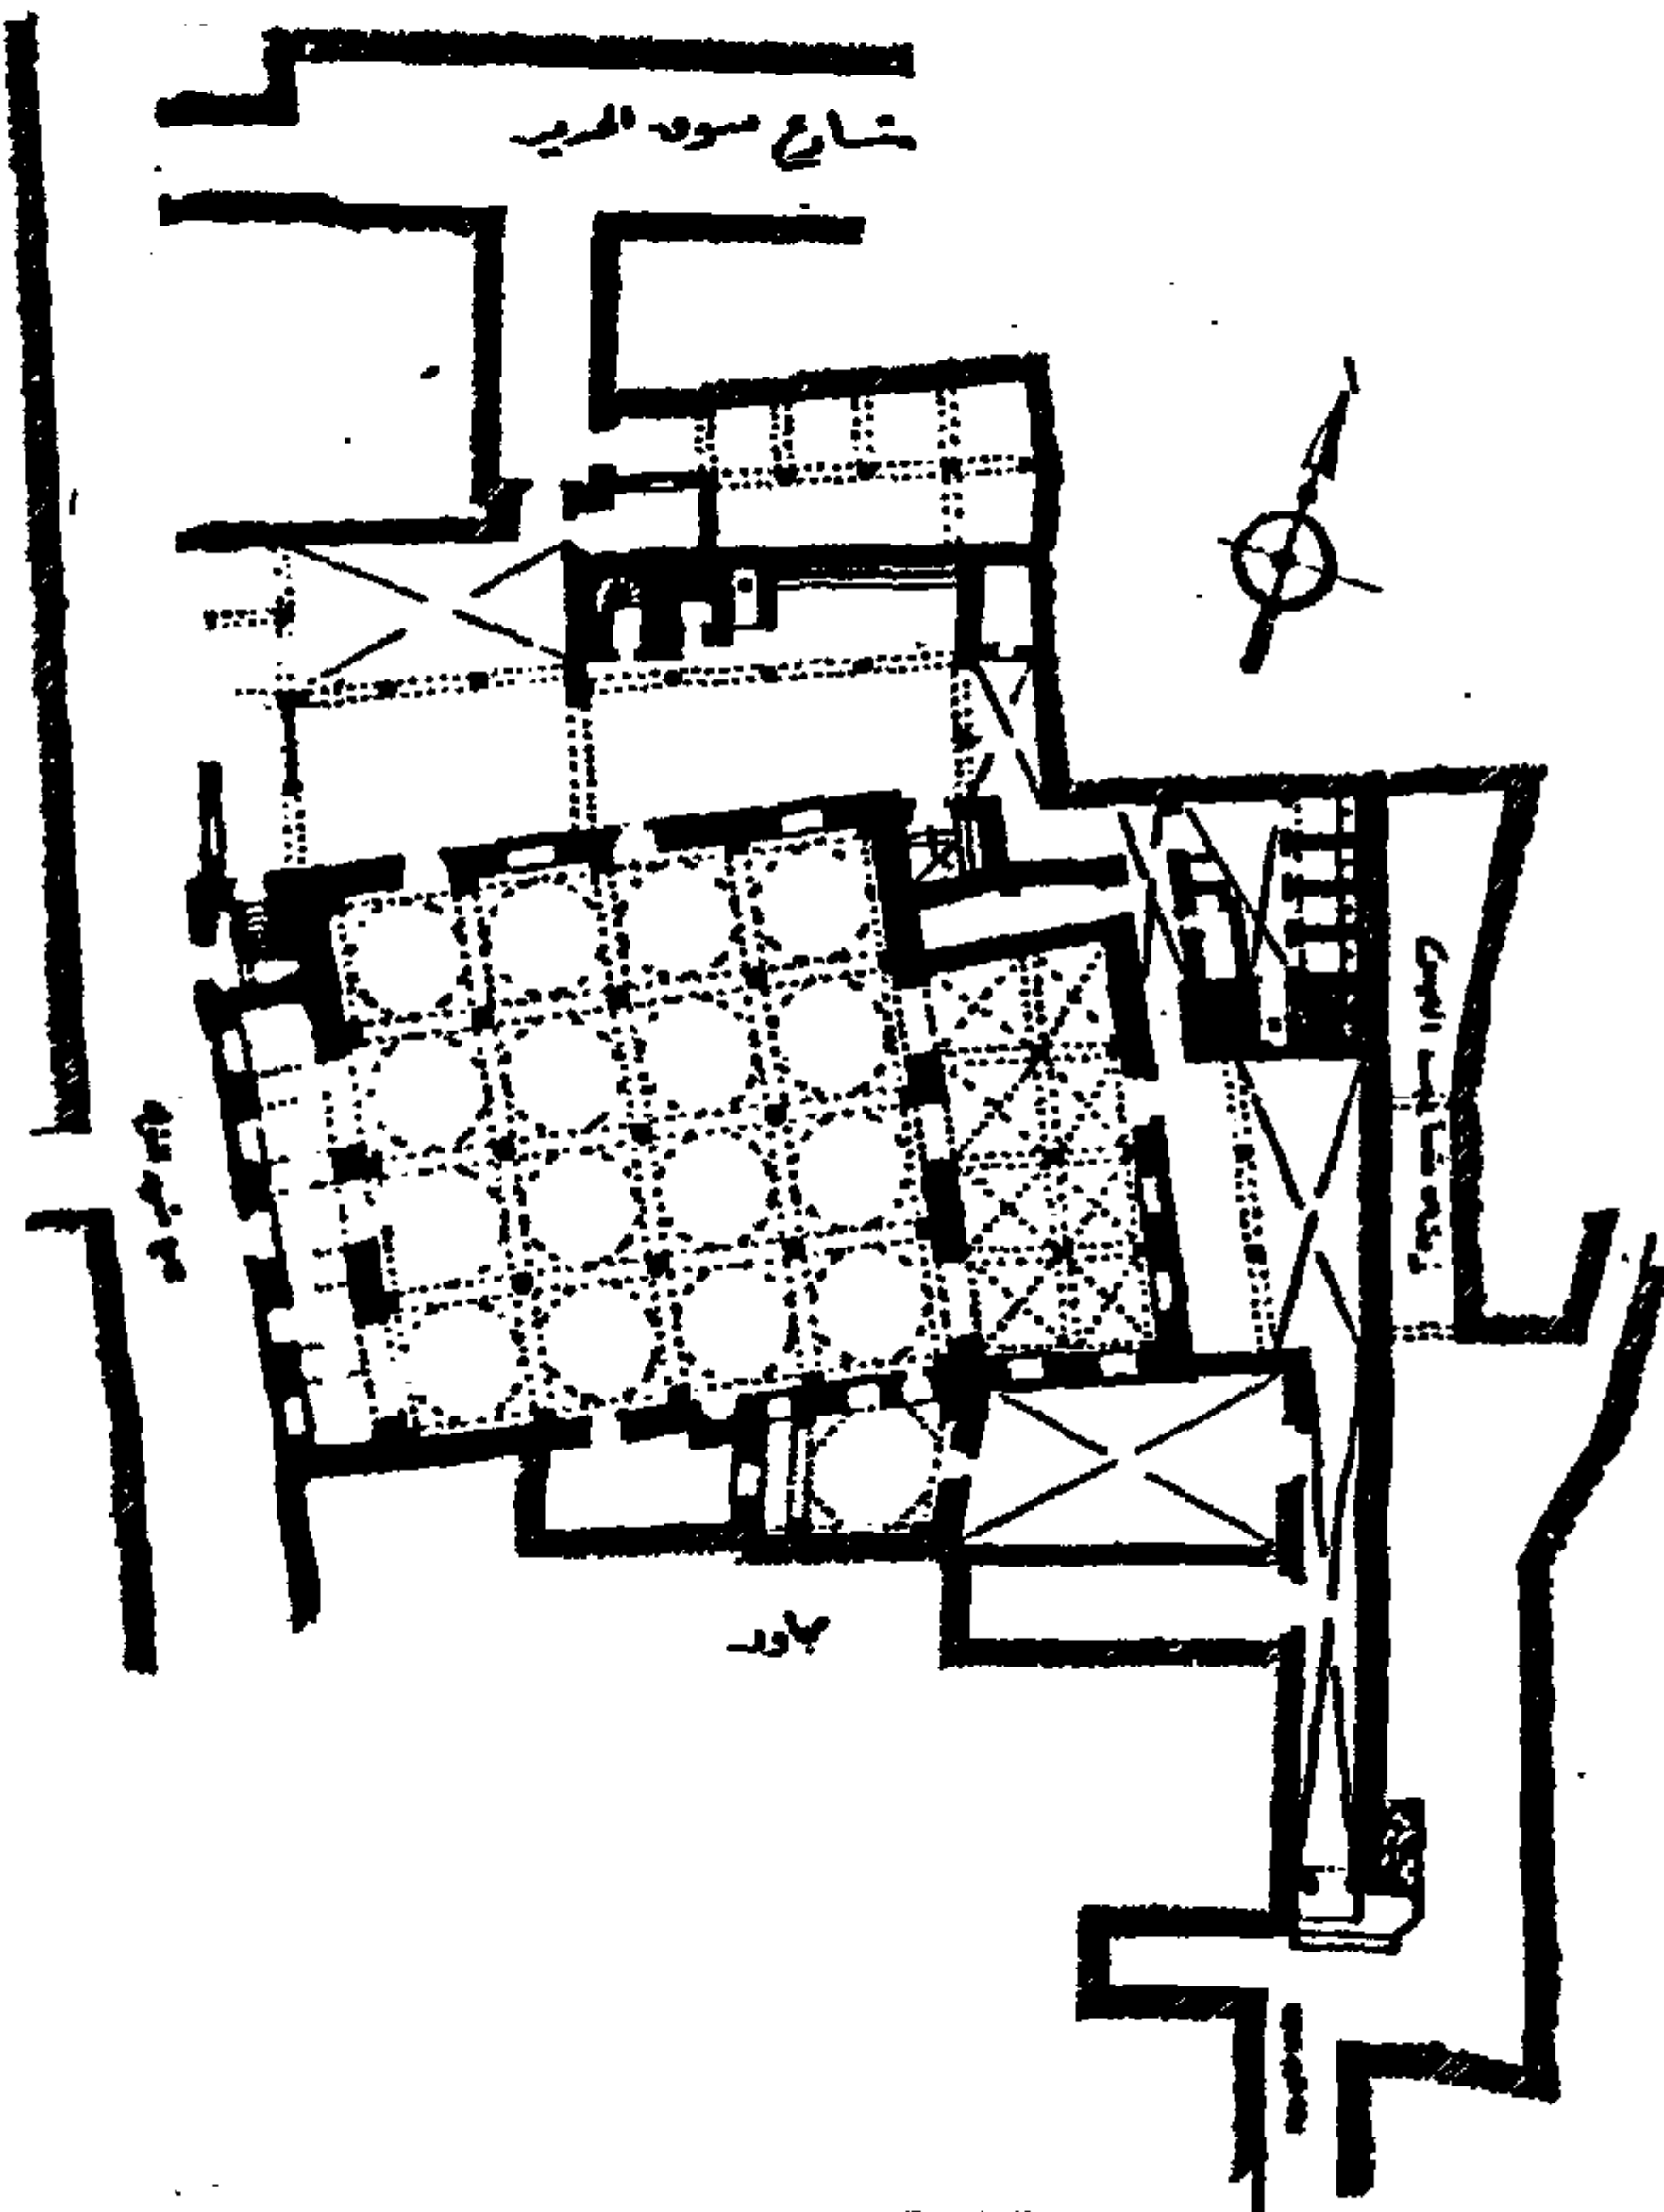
مسقط أفقي لمسجد النخلي عن موسوعة الآثار الإسلامية.
